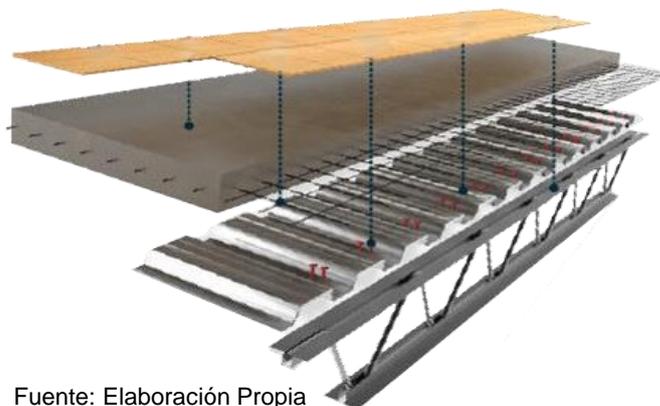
Axonometría Explotada del Sistema de Vigas Joistec
